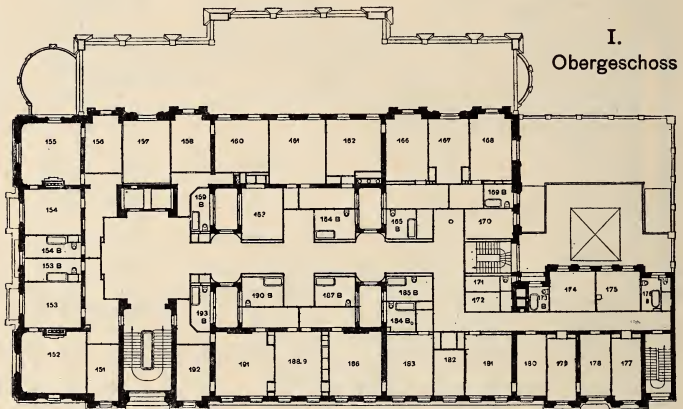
Hotel Esplanade, Hamburg. Grundriß.
